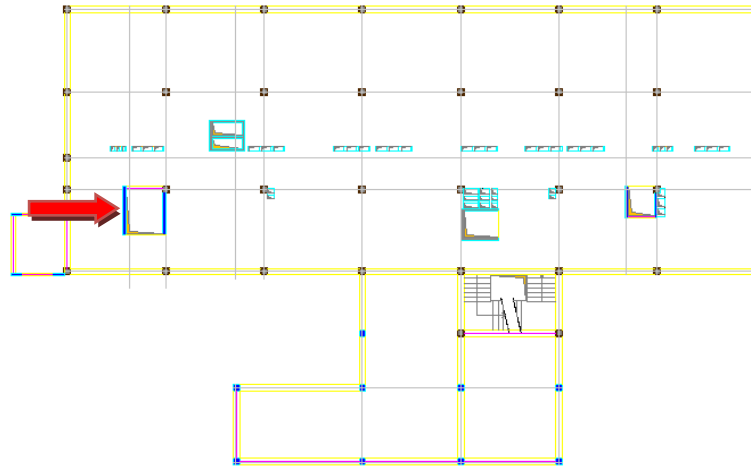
Planta estrutural do piso 0 (adaptado de [42])
